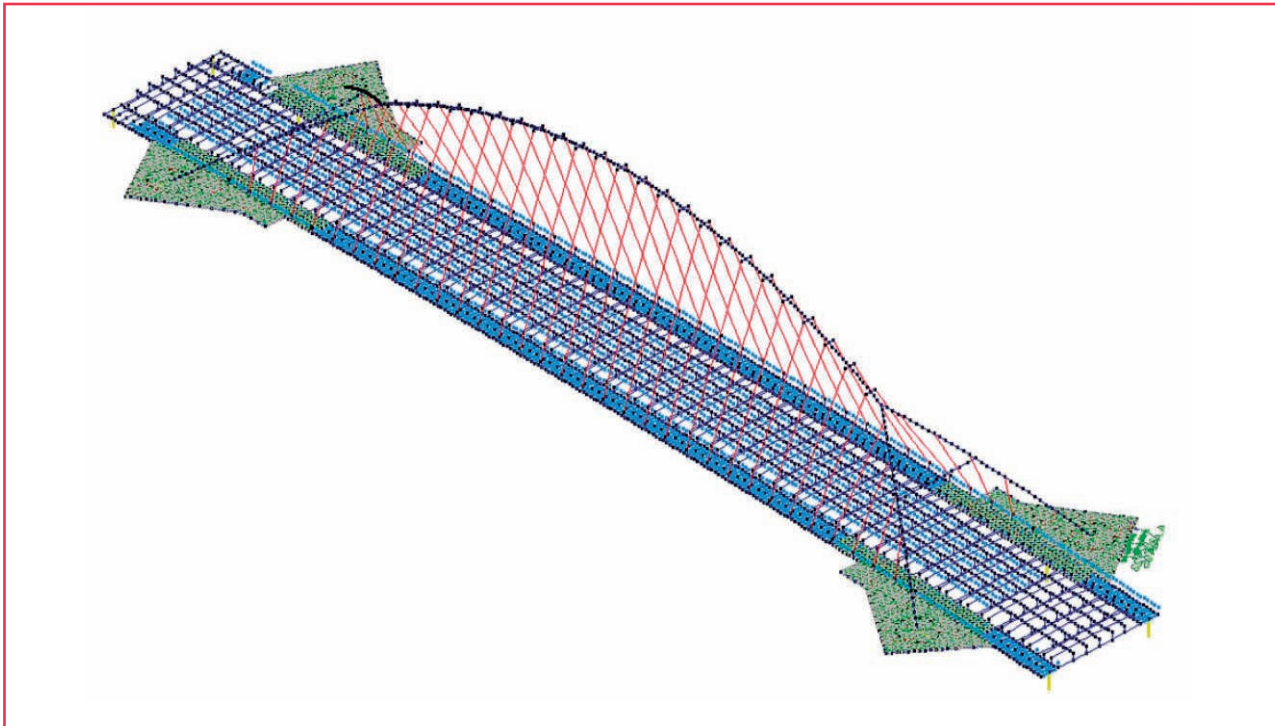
Vista de uno de los modelos globales del puente, en este caso en su fase constructiva final.
